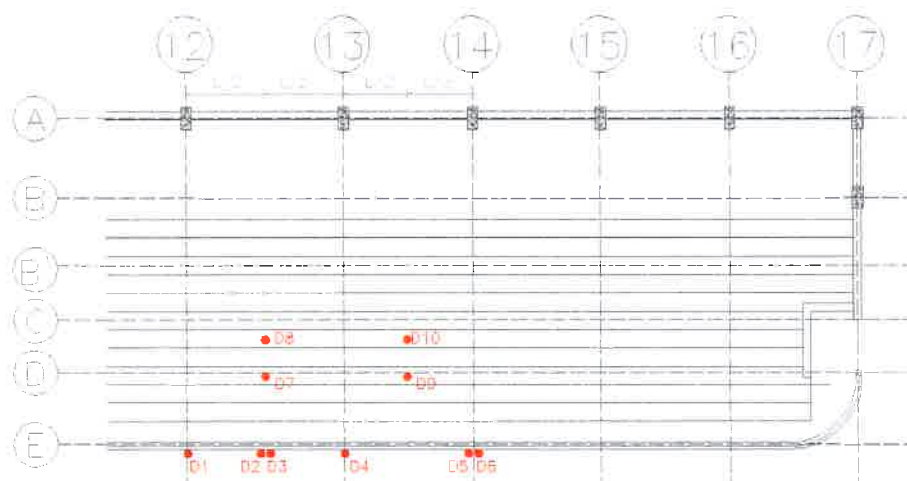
Desenho esquemático em planta do posicionamento da instrumentação instalada.
